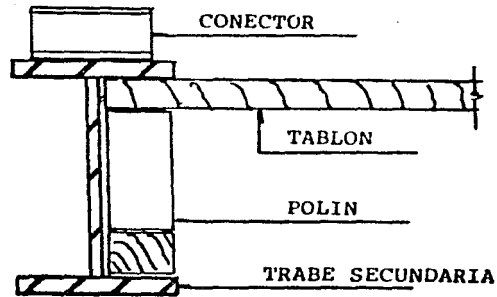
SECCION TRANSVERSAL DE LA LOSA DE PUENTE.
